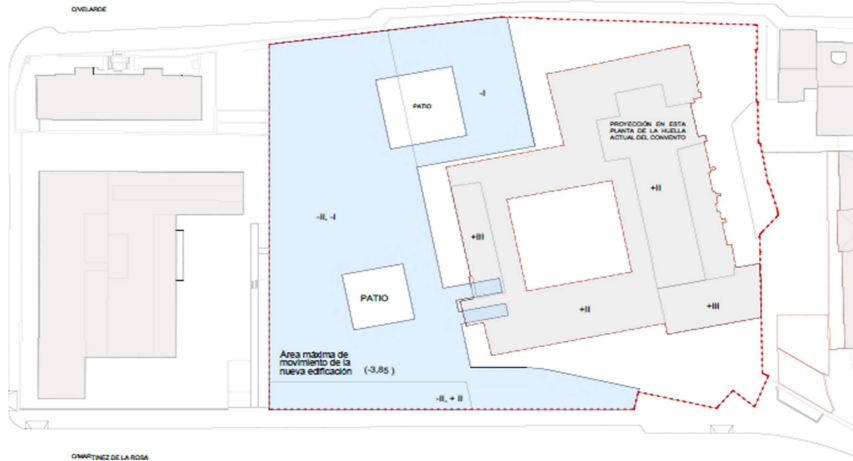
Ordenación del ED. Ocupación en Planta Sótano
